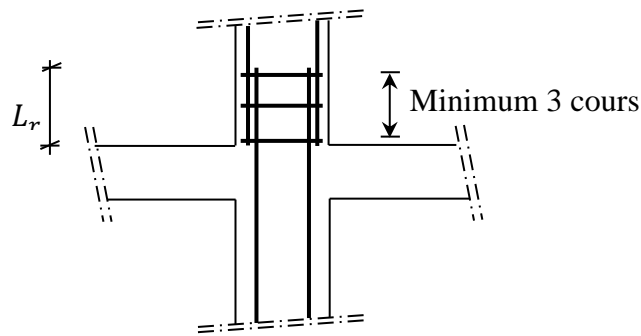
Les armatures transversales dans la zone de recouvrement
